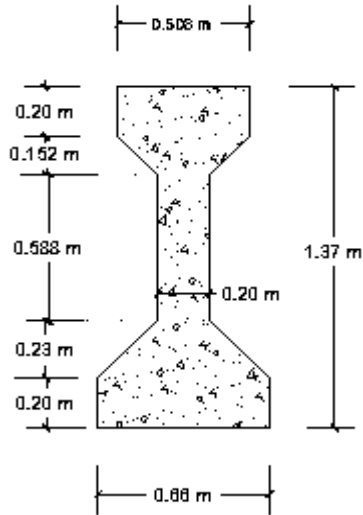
Dimensiones geométricas de la Viga AASHTO
